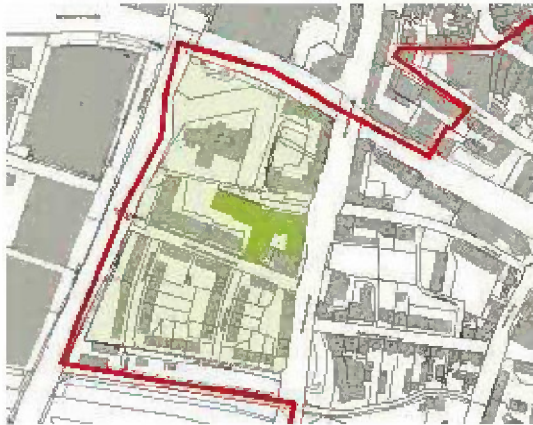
Lageplan Ramada Hotel, Bestandsgebäude Ramada Hotel
